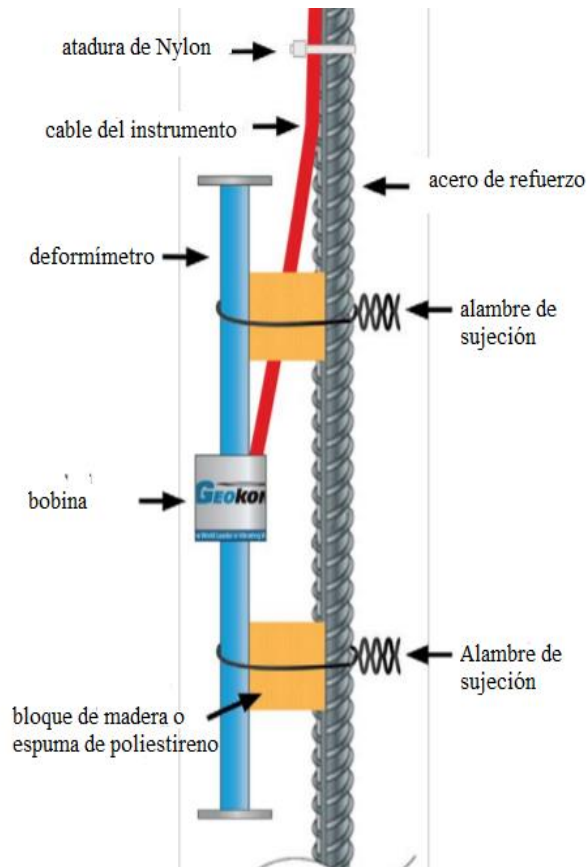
Instalación de deformímetro (adaptada de GEOKON, 2016)
